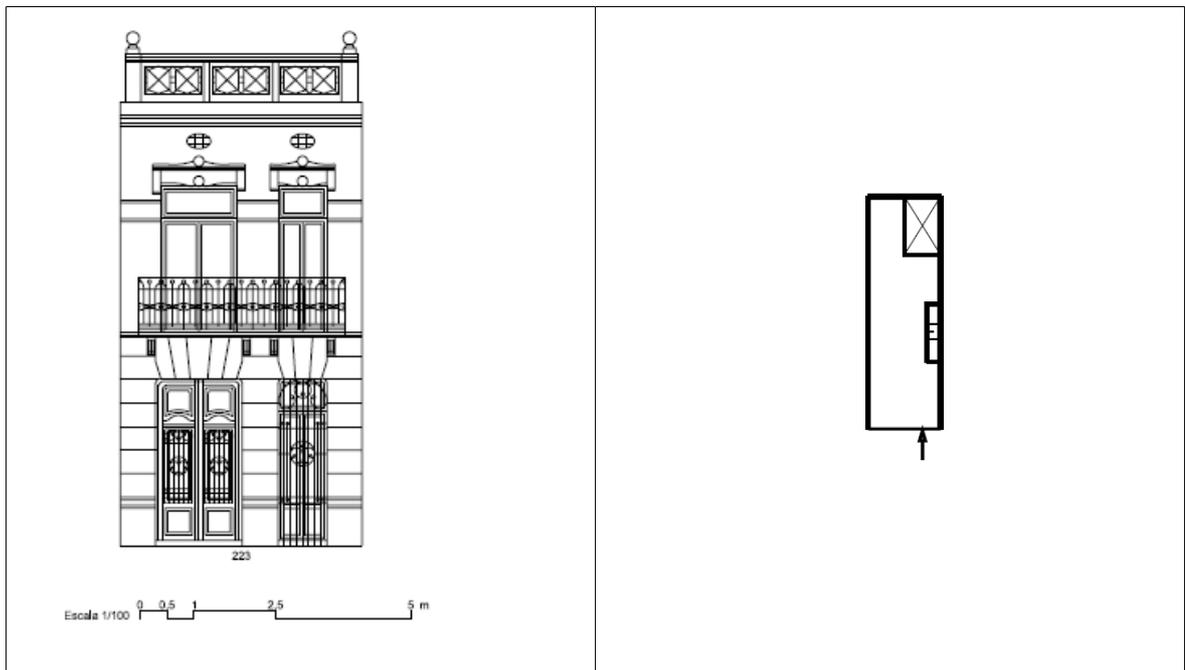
Tipo A21. Ejemplo de fachada y esquema de planta (ficha 215-21)
